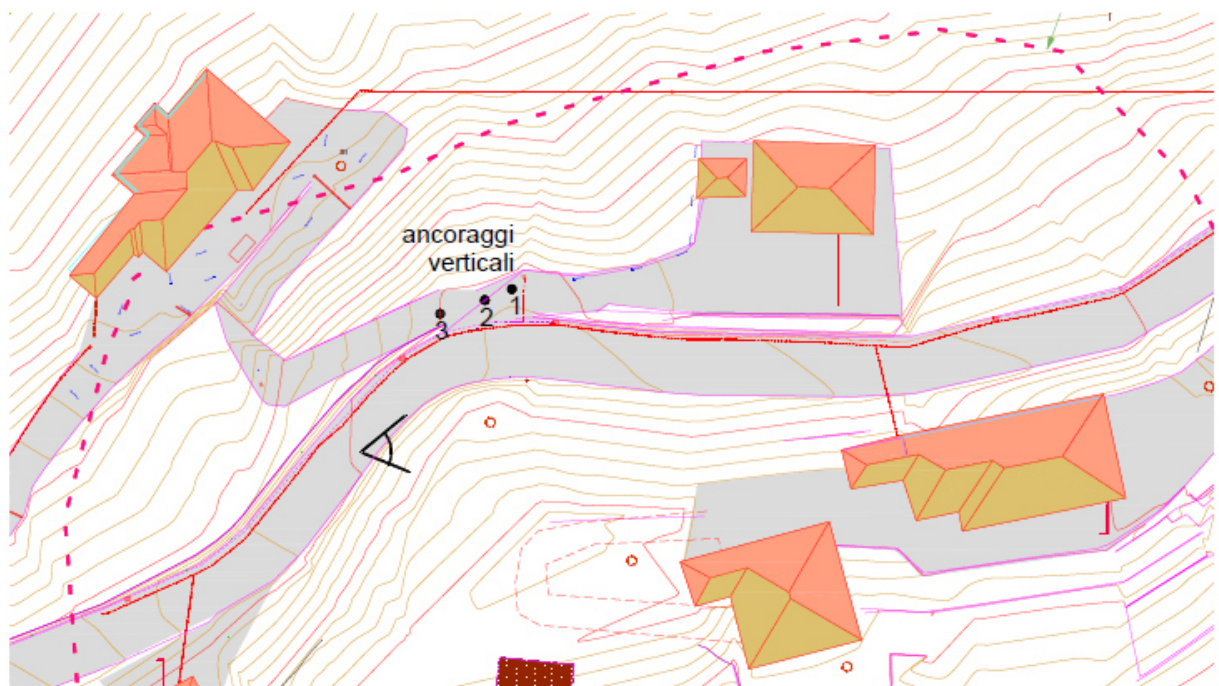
, Pianta con posizione degli ancoraggi verticali
